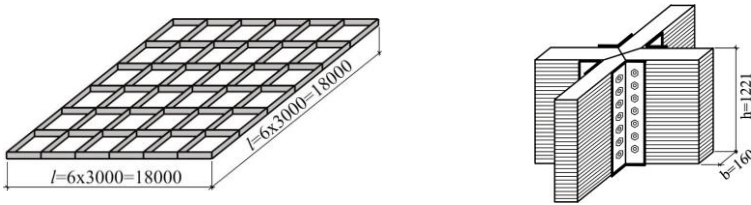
Схема системы перекрёстных балок и узел примыкания элементов
